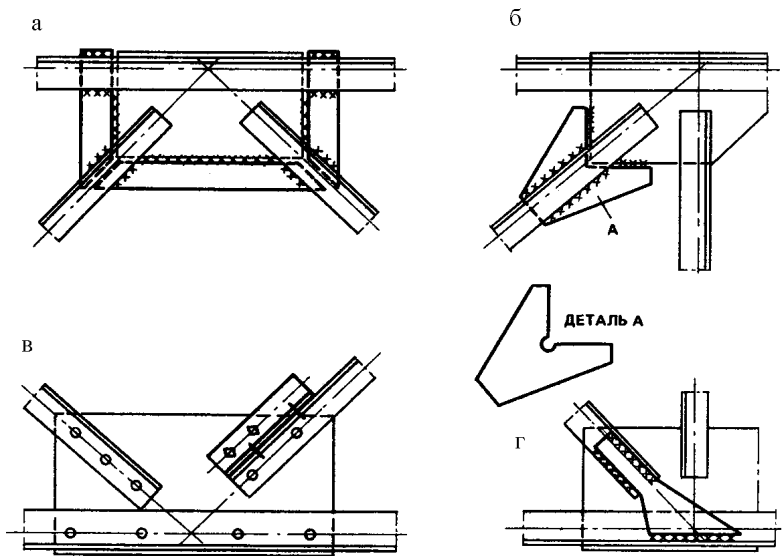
Підсилення вузлів кріплення стержнів кроквяних ферм
